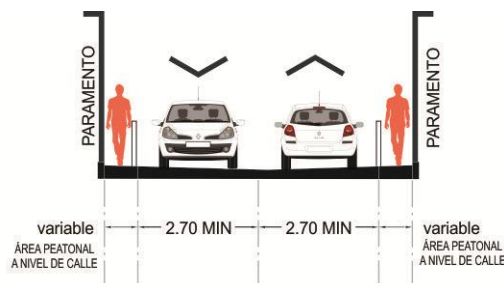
Sección Mínima sin banqueta.
